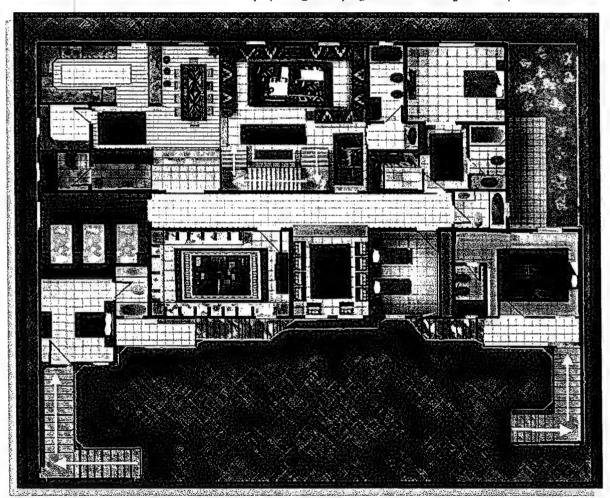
مسقط أفقي للدور الأول (العلوي) (نموذج رقم ٣)
